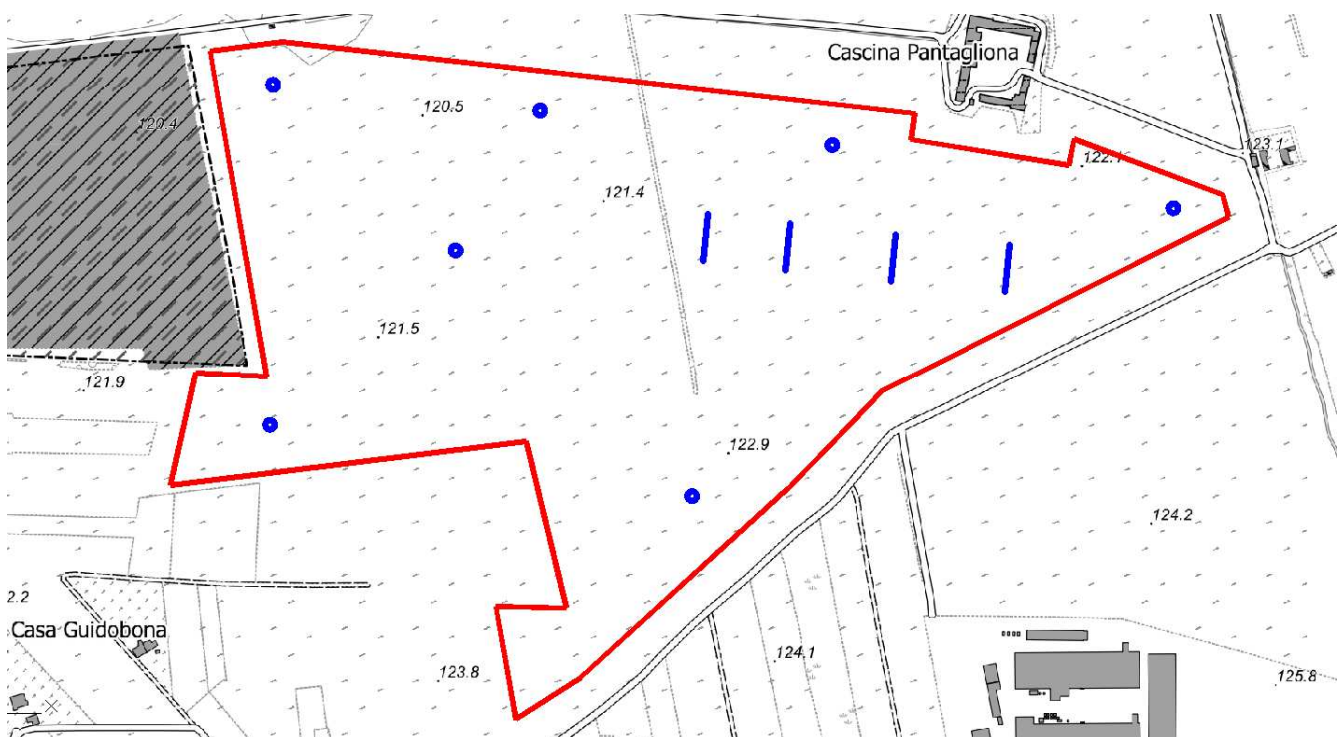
Proposta di collocazione planimetria dei sondaggi e delle trincee
